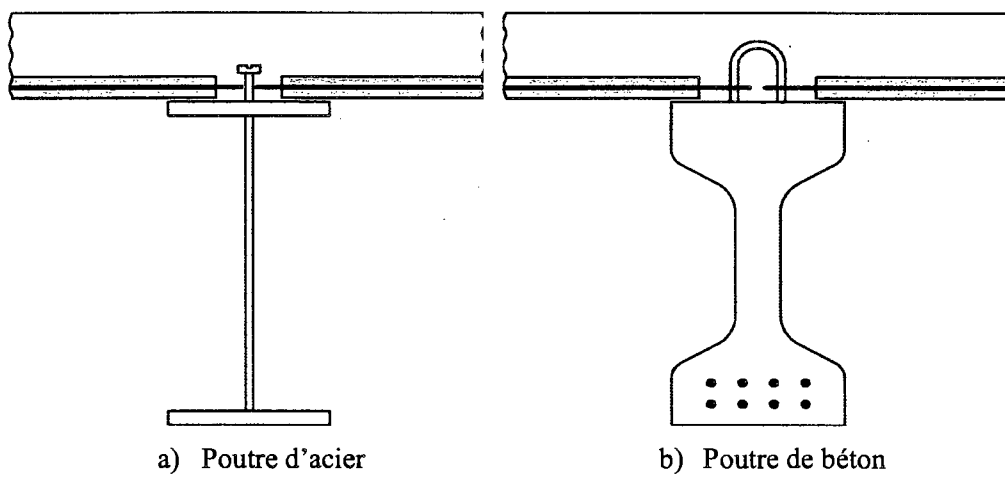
Connexions poutre, pré-dalles et dalle coulée sur place
